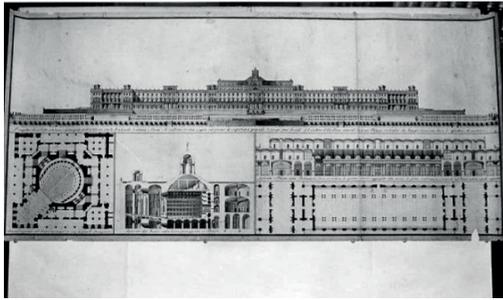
L. Vanvitelli, *Reggia di Caserta, Prospetto di un lato dell'edificio; pianta del teatro; spaccato del teatro; spaccato e pianta della Biblioteca
